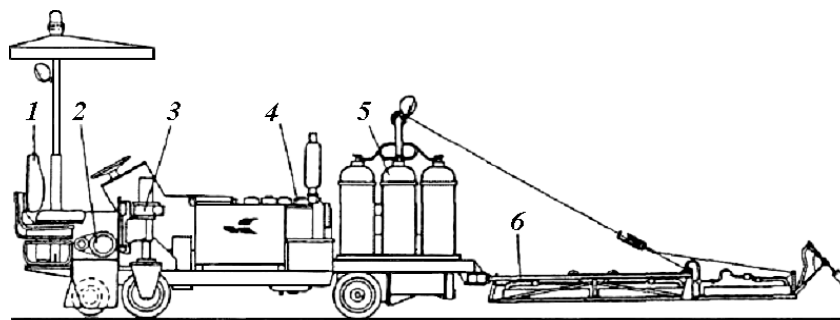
Машины для разогрева и фрезерования асфальтобетонных покрытий при ремонте: 1 – место оператора; 2 – привод и фреза для отделения разогретого асфальтобетона; 3 – ходовое устройство; 4 – двигатель; 5 – резервуары для газообразного топлива; 6 – нагревательная система
